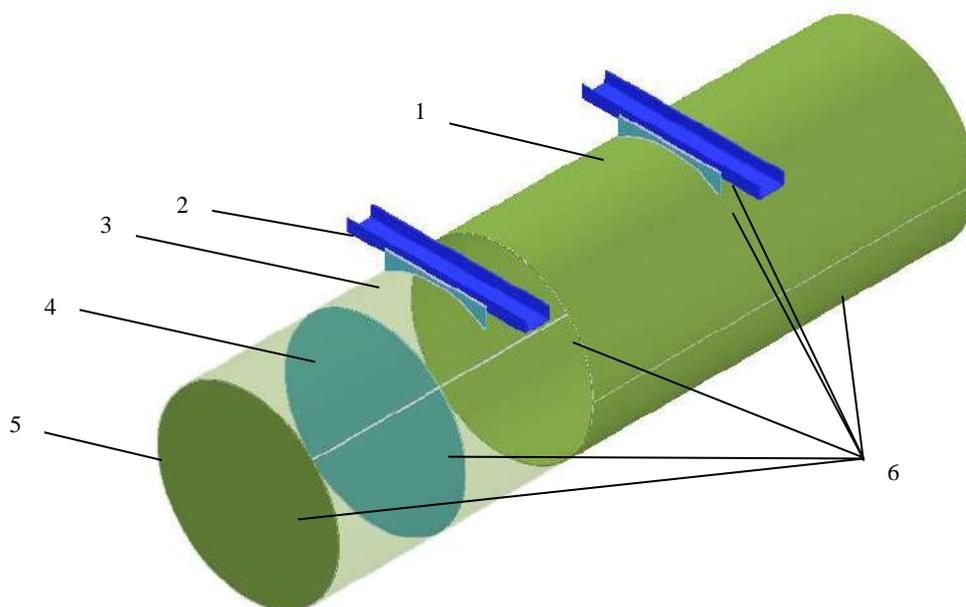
Цилиндрический понтон сборно-разборного наплавного моста
